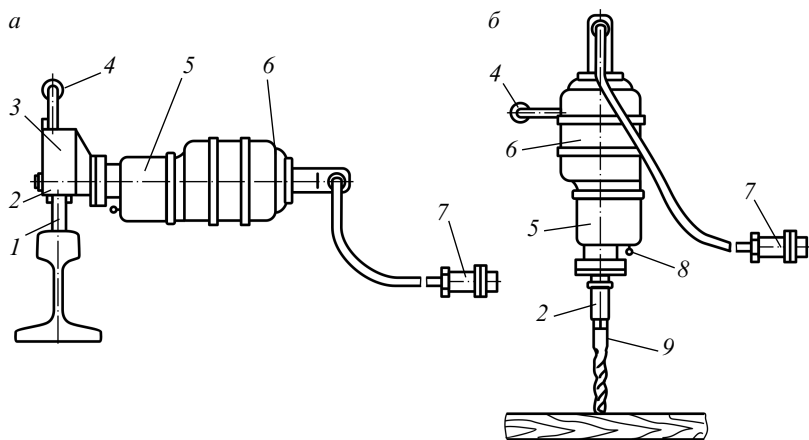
Положение сверлошлифовалки СШ1 при шлифовании головки рельса (а) и при сверлении шпалы (б):
